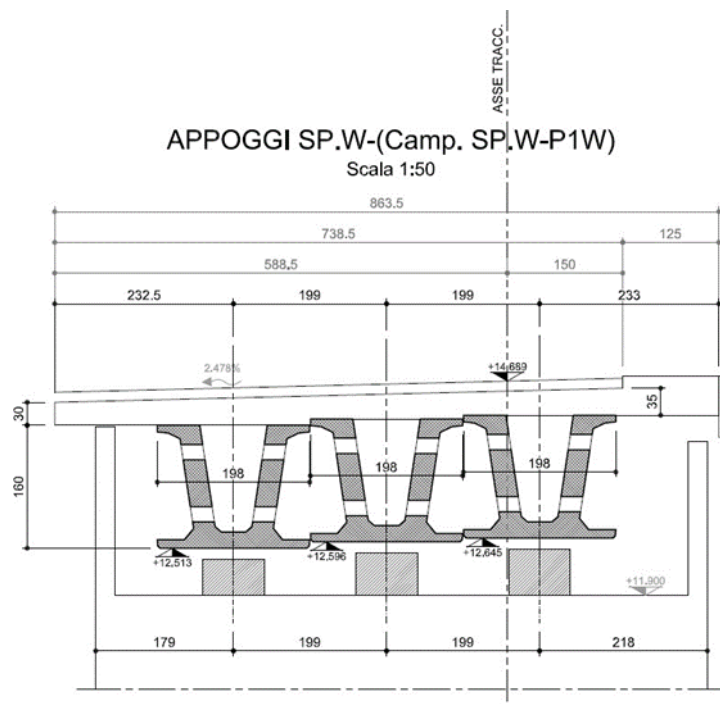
Sezione trasversale Campata 1 (a 3 travi) – Rampa W – SP_W
